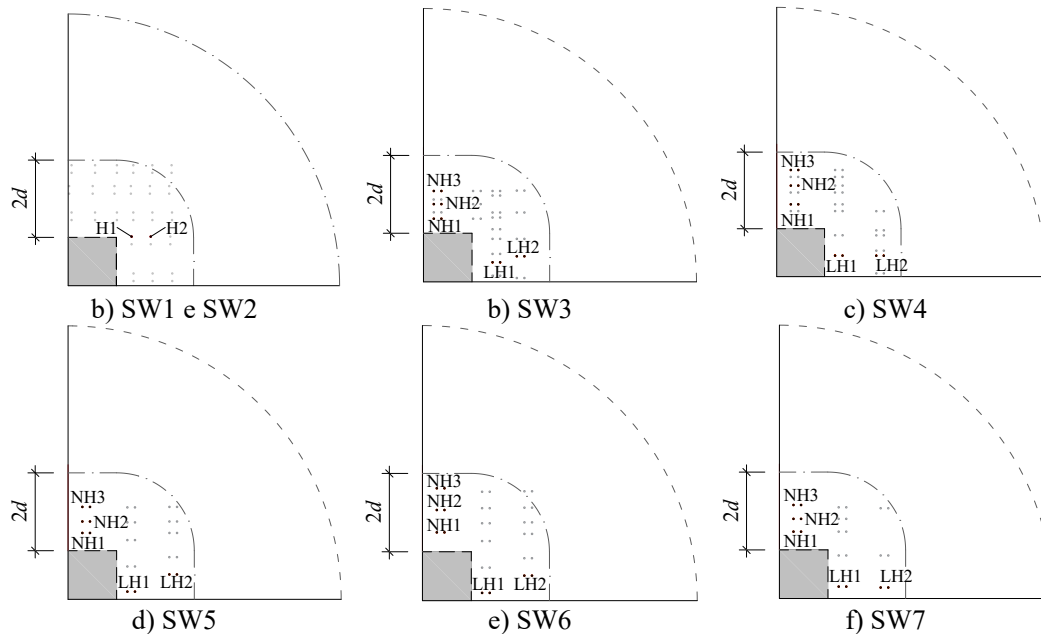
Posicionamento da instrumentação dos ganchos “U” da segunda série.
